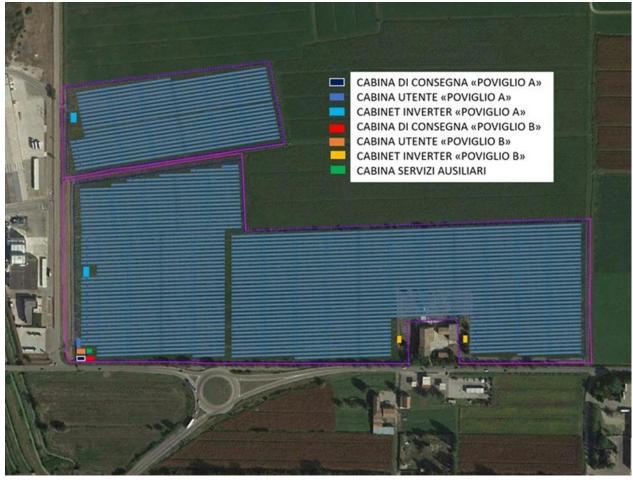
Assetto di progetto dell'impianto fotovoltaico (Relazione tecnica generale)
